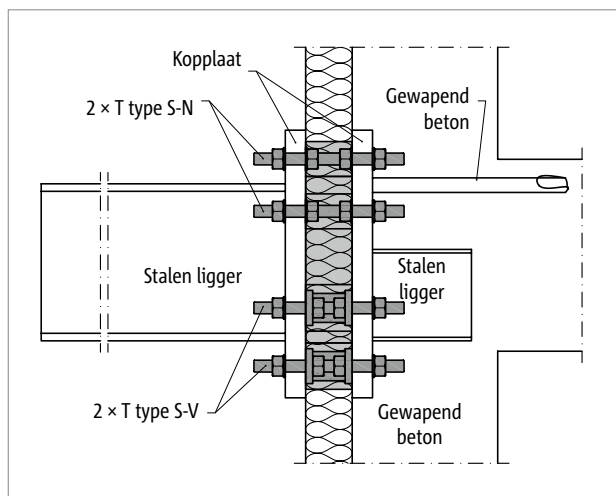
Schöck Isokorf® T type S: Buitenhoek
